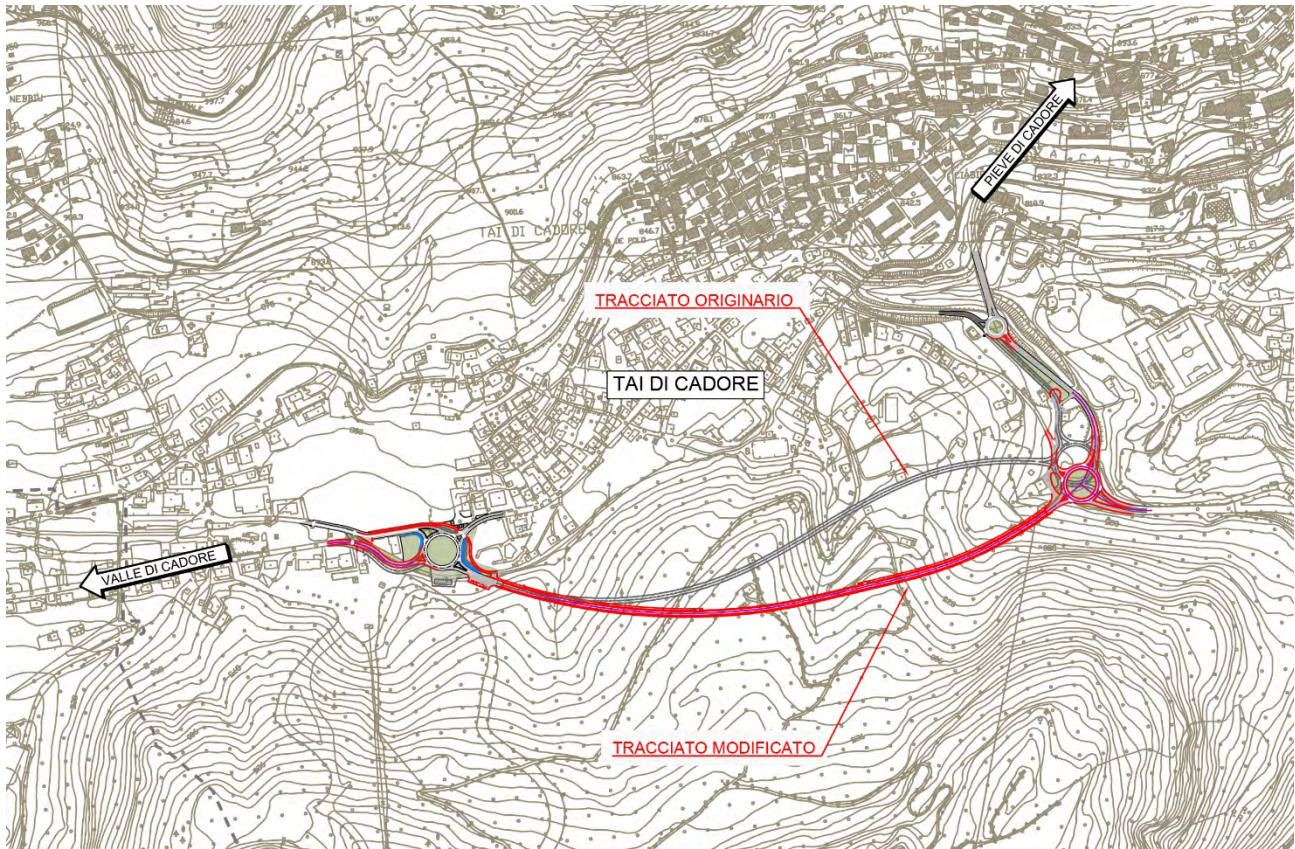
Confronto planimetrico del tracciato oggi proposto con il tracciato precedentemente proposto e corrispondente all'alternativa 1 dello studio di impatto ambientale.
